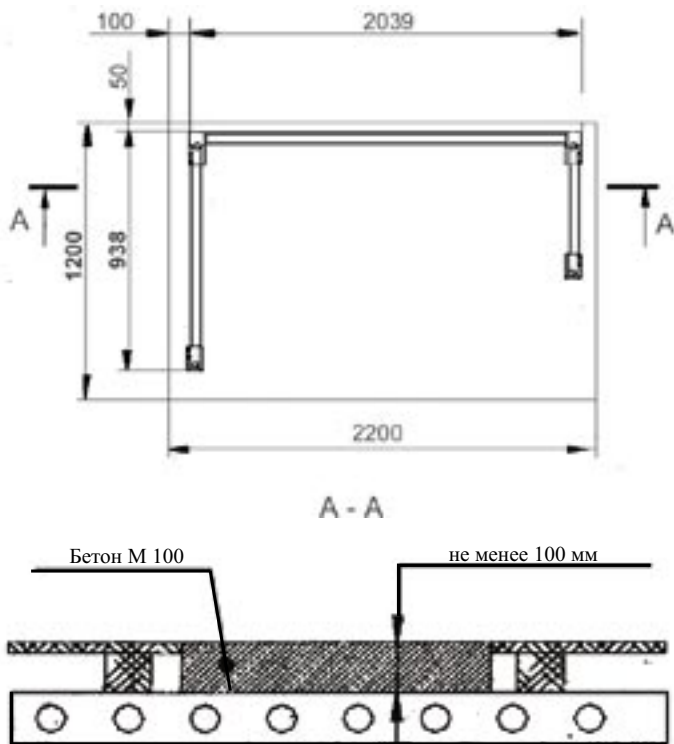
Фундамент под «Унискан» в помещении с деревянным полом
